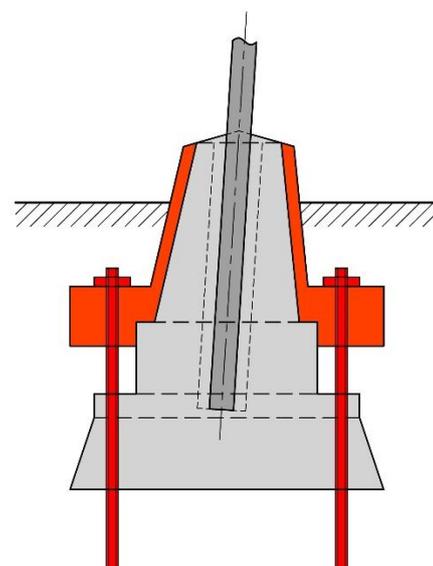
Verstärkung mit Betonkragen und Mikropfählen
